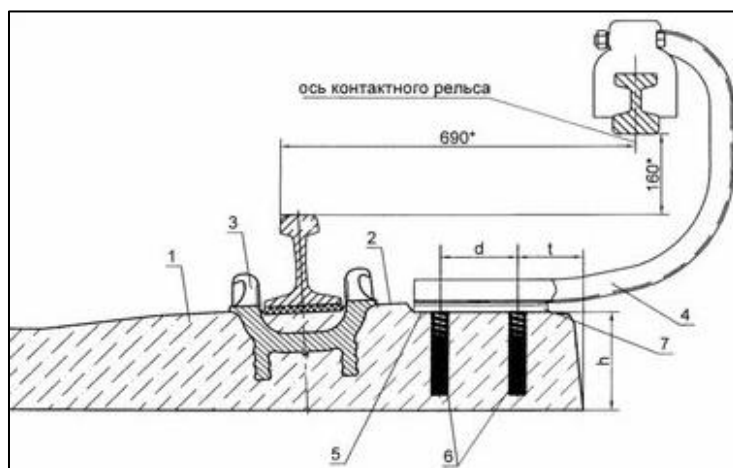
Vue en coupe du montage 3^e rail installé sur le métro de Moscou
